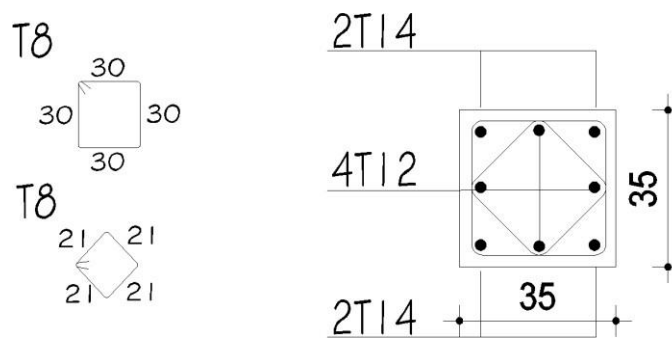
Dessin de ferrailage de poteau (35×35).
